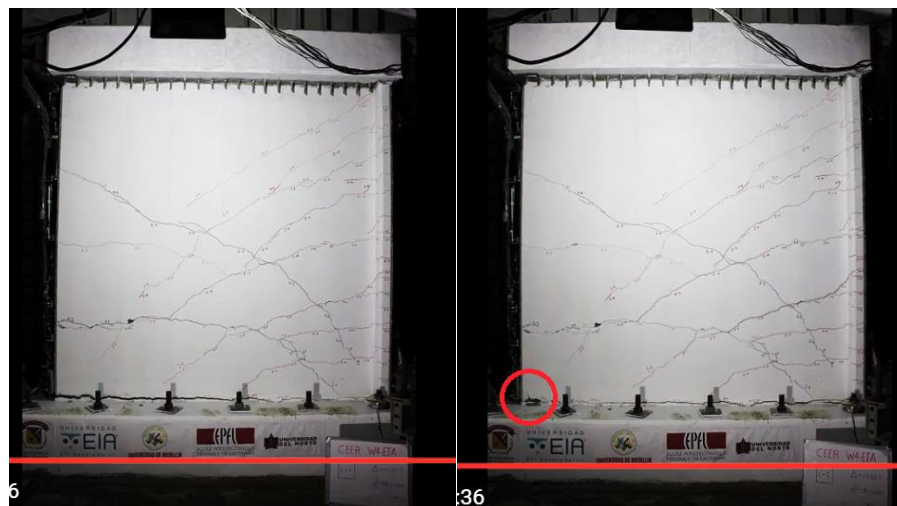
Falla del espécimen. (a) fractura a tracción del refuerzo del alma en la base del muro para estado de aleta a compresión. (b) aplastamiento del concreto del alma en la base del muro para el estado de aleta a tracción.
